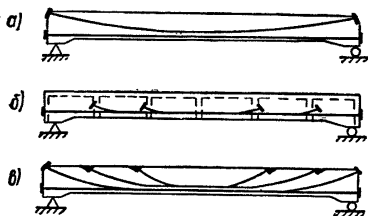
Примерные схемы армирования разрезных балок арматурой прямолинейного и криволинейного очертания
